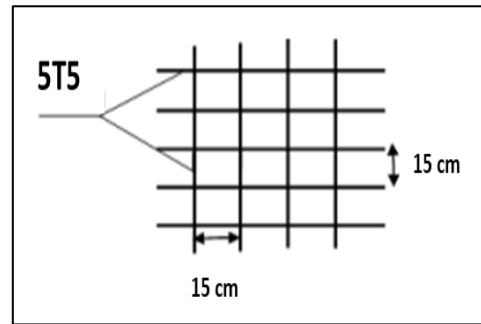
Disposition du treillis soudé dans un plancher en corps creux
